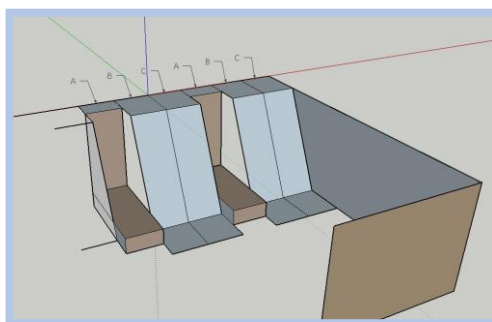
Posteriormente, empieza la excavación con los bataches A, debiéndose terminar completamente el muro de dicho tramo. Luego siguen los bataches B y C.
